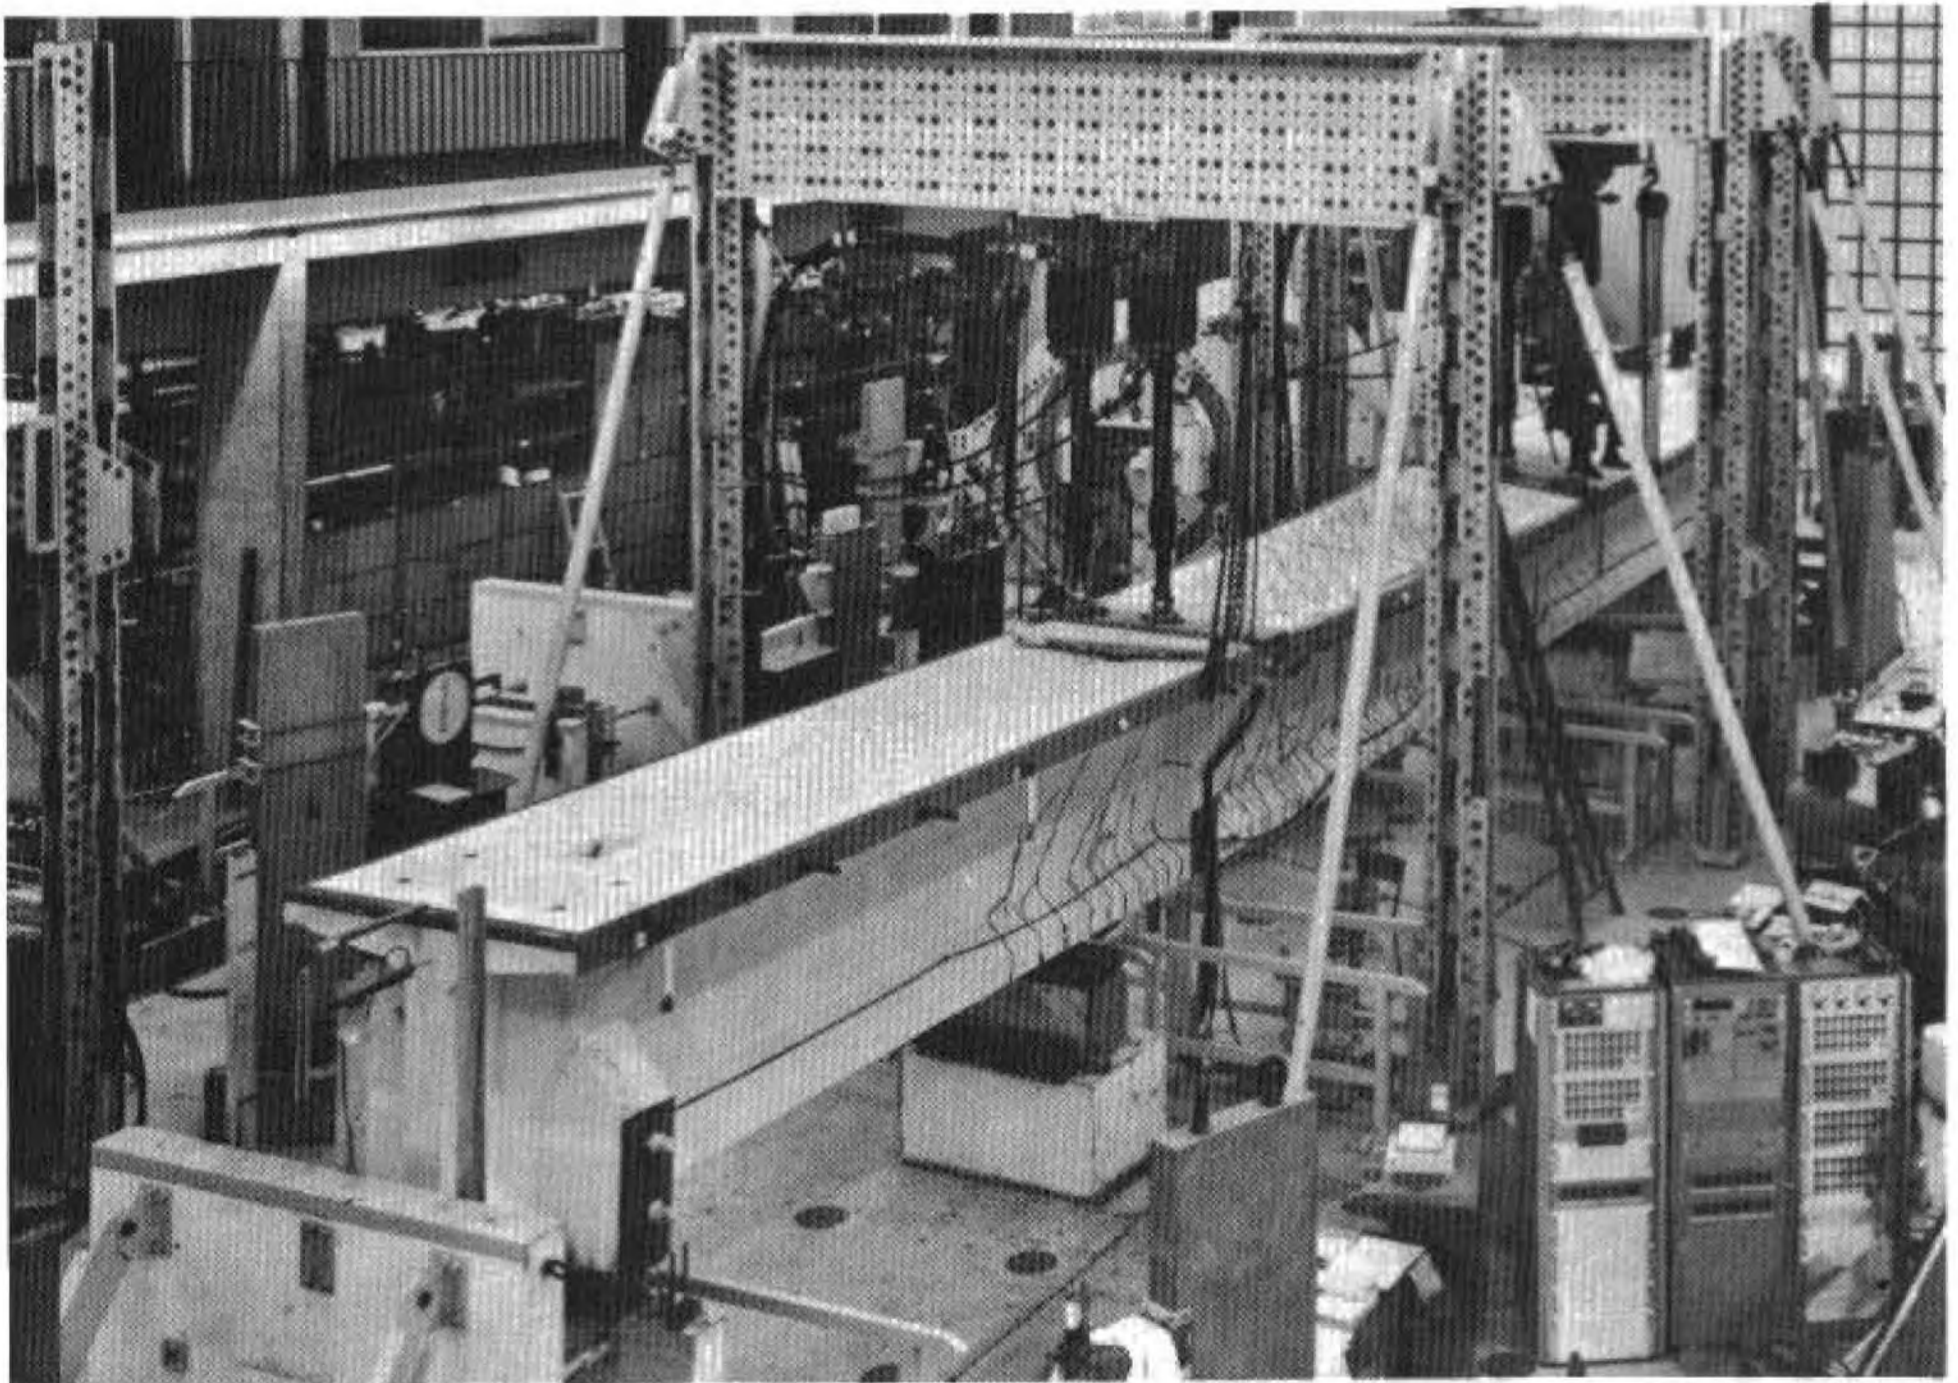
Essai en vraie grandeur d'une poutre de 20 m en béton précontraint, sollicitée en flexion-torsion (doc. C.E.B.T.P.).
